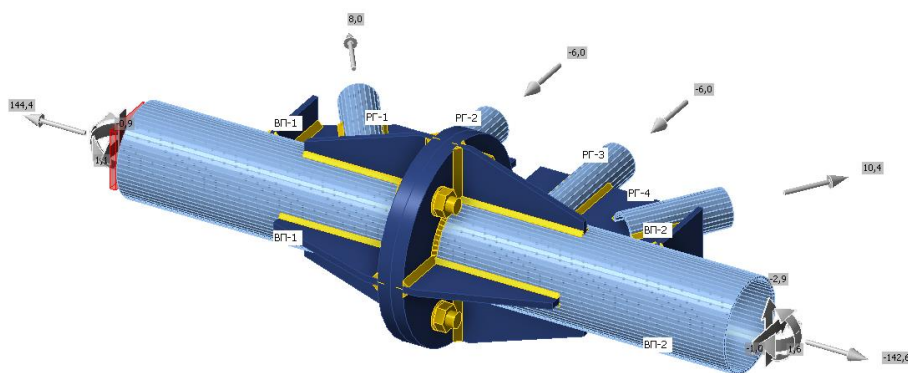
Монтажний стик нижнього поясу просторового блоку ферми
